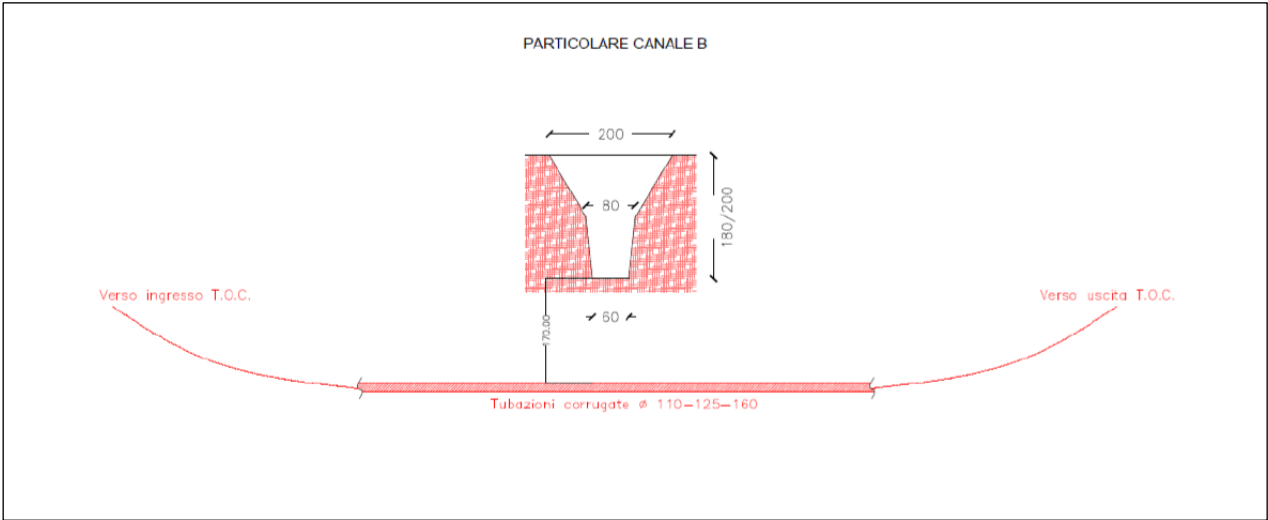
Dettaglio attraversamento in T.O.C. canale B
